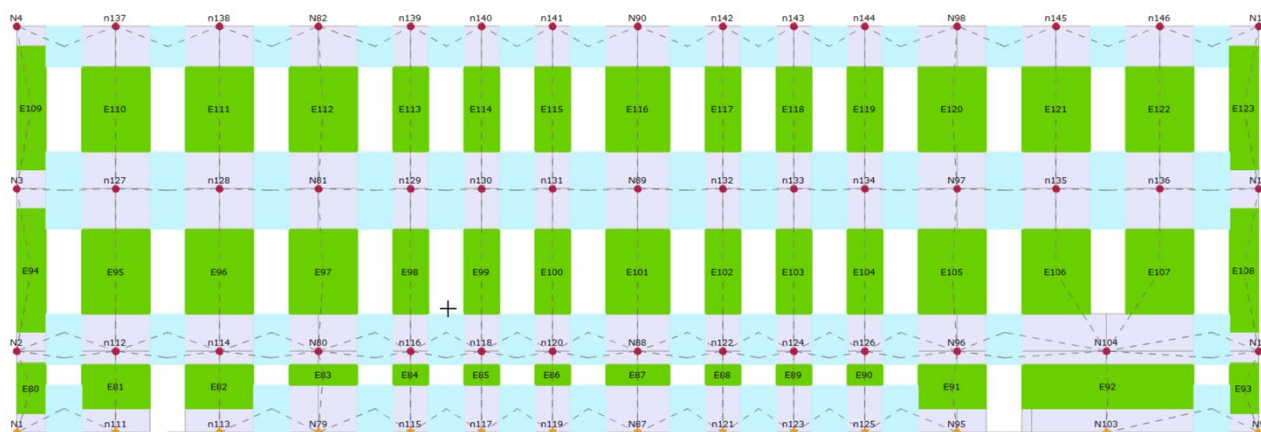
Sollecitazioni Parete P2 | Prospetto Sud-Est
